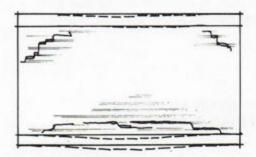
FISURAS EN LOS MUROS DE OBRA DE FABRICA
